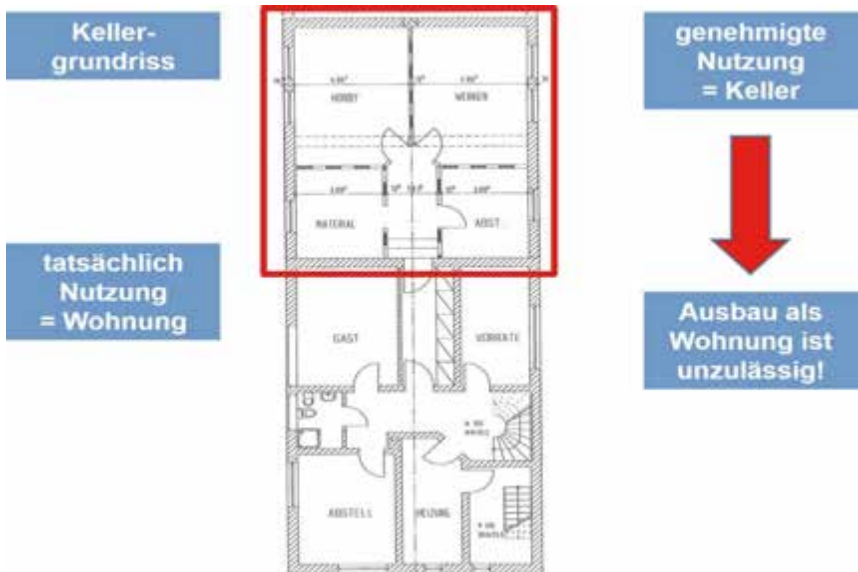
Kellergrundriss gemäß Eigentümerakte
